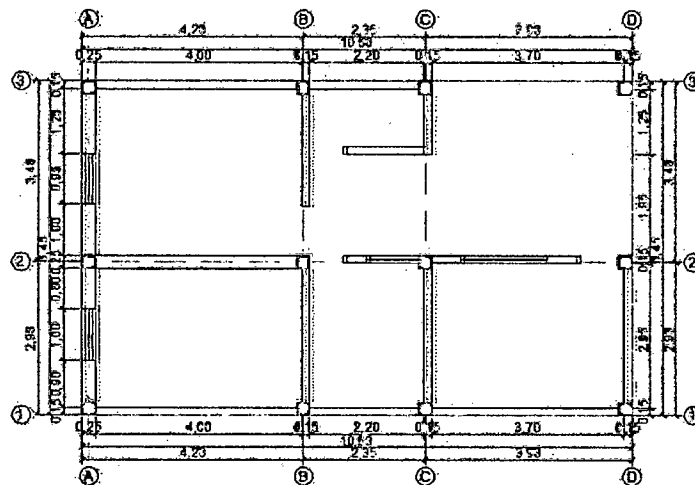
Plano de arquitectura de la planta típica de la Vivienda TV2.
